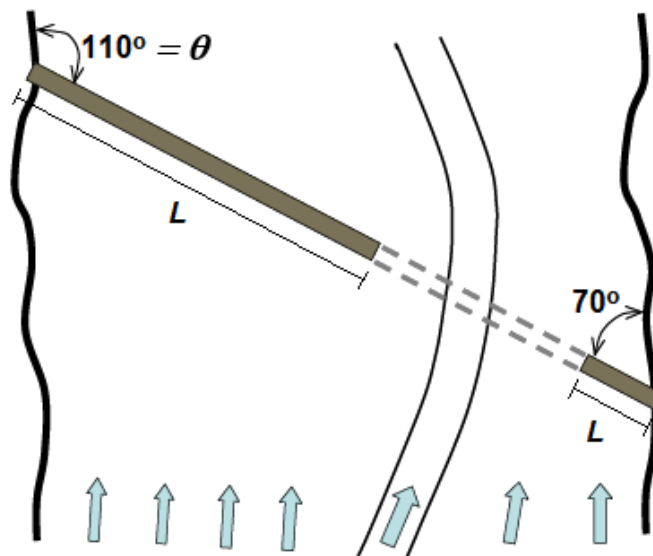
Calcolo dello scalzamento in corrispondenza delle spalle
